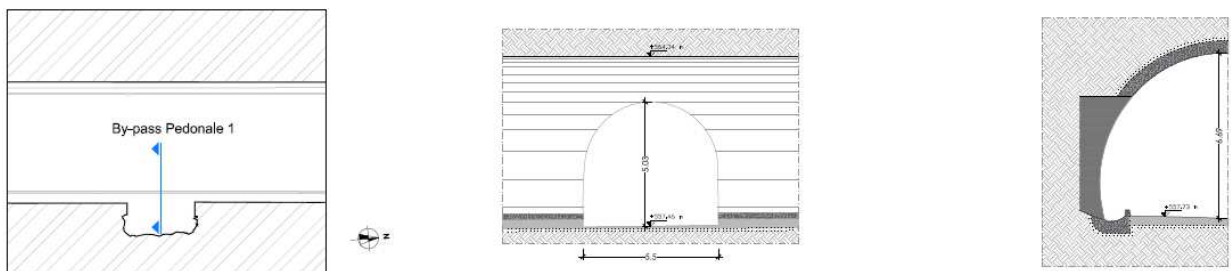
Planimetria, prospetto e sezione by pass pedonale
